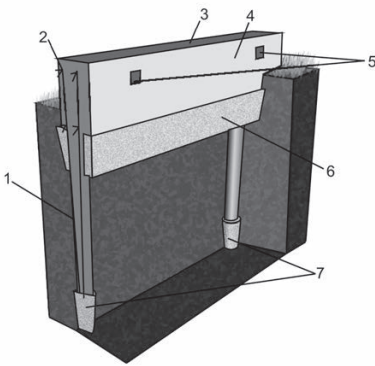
Фундамент из висячих свай: 1 — арматурный каркас; 2 — арматура; 3 — гидроизоляция (два слоя); 4 — бетон; 5 — вентиляционное отверстие; 6 — песчаная подушка; 7 — песчаная подушка 300 мм
